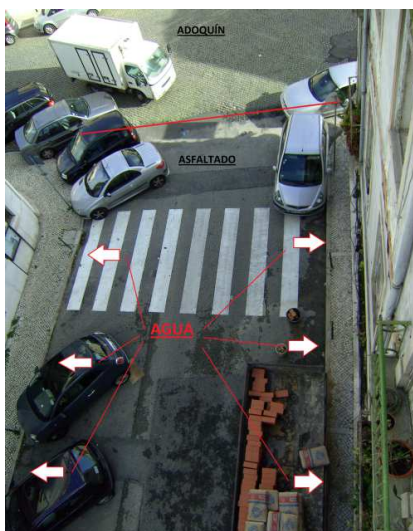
Asfaltado del pavimento adoquinado en la calle Rua Da Bempostinha que propicia el efecto chimenea
